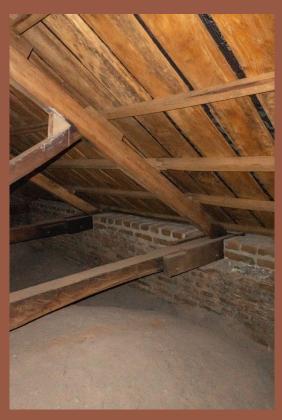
Interior de las bóvedas. Se puede observar la estructura de la cubierta y de la bóveda de piedra pomez. Por autoras.
